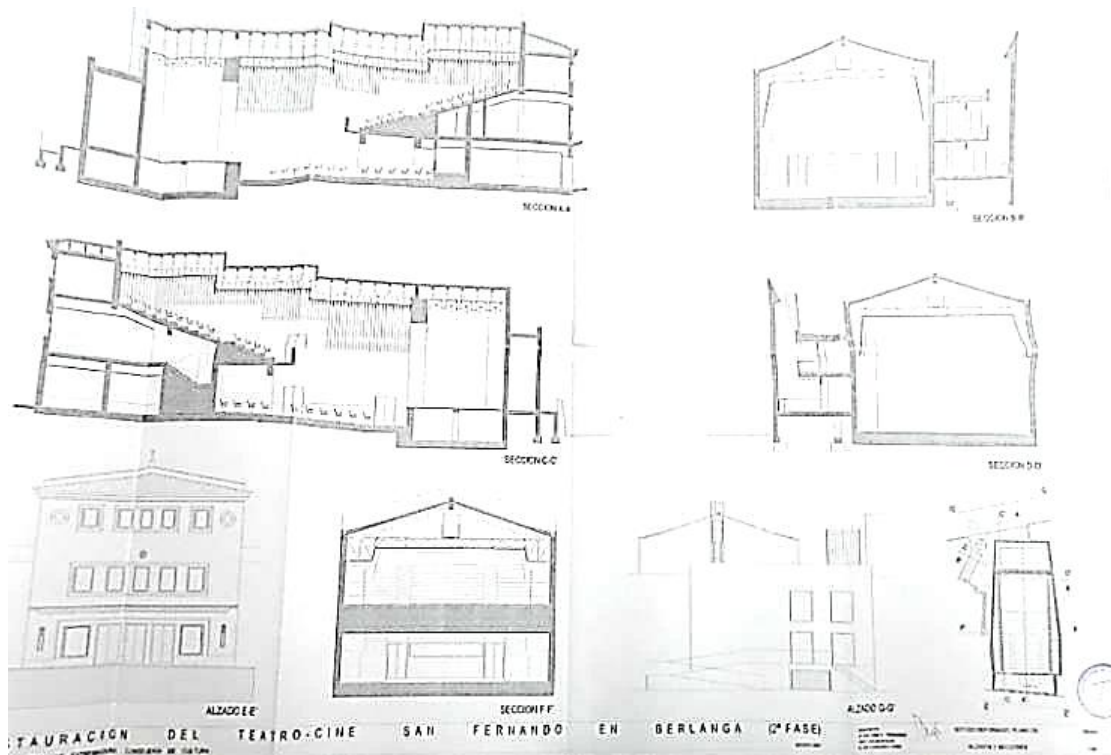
Plano de secciones reformadas en la II Fase (PRIETO FERNÁNDEZ, J., 2000).
